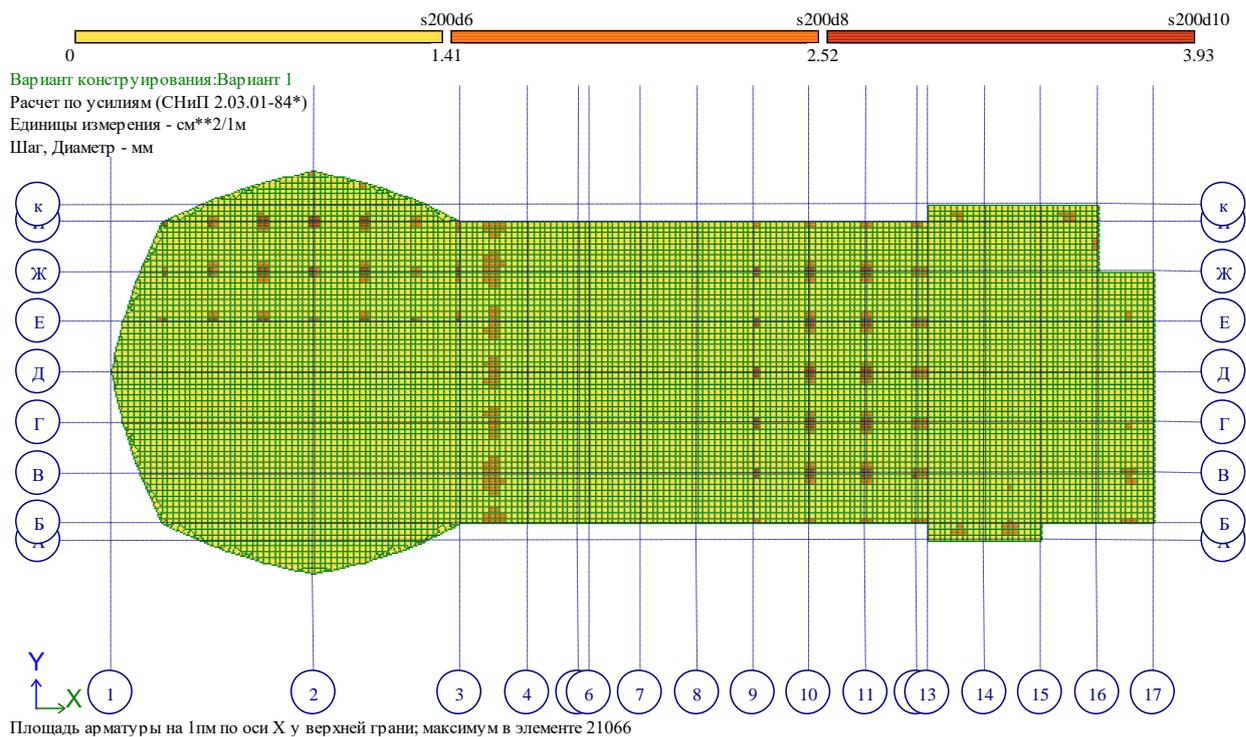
Площадь арматуры по оси X у верхней грани
